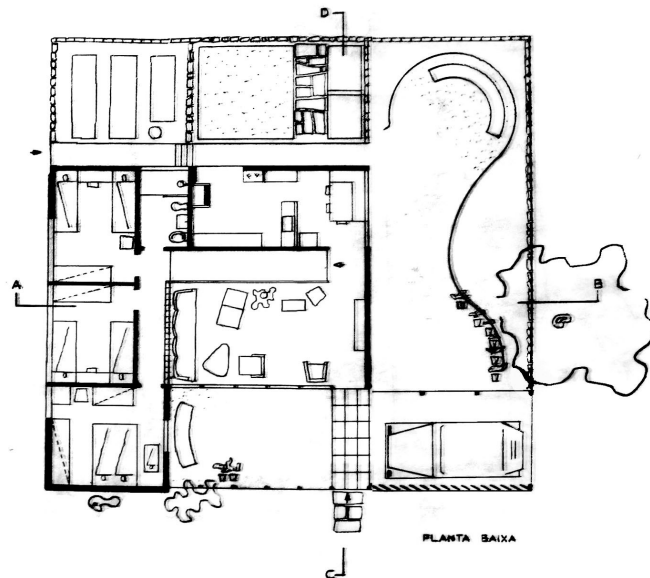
Planta com estudo de interior: preocupação com a utilização do espaço e mobiliário. Fonte: Arquivo INSS.
